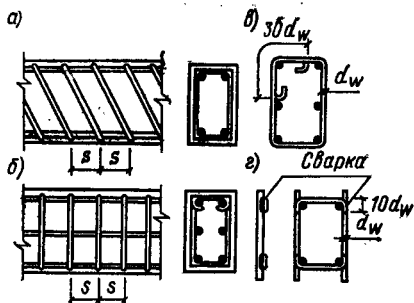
Армирование элементов прямоугольного сечения, работающих на изгиб с кручением
